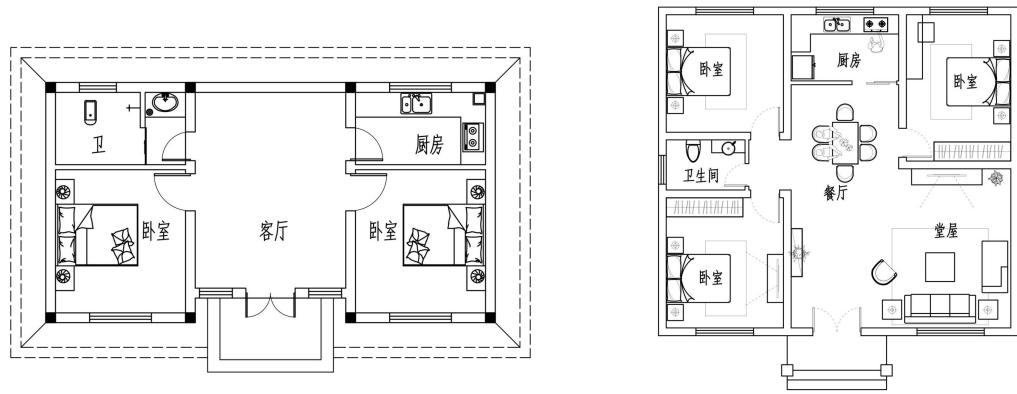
一层现代宜居农房平面图示例 1 图 B.0.2 一层现代宜居农房平面图示例 2
